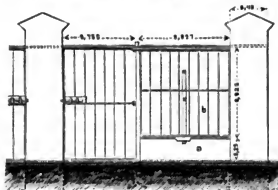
u. 876. Eiserner Schweinef Stall-Einrichtung.
